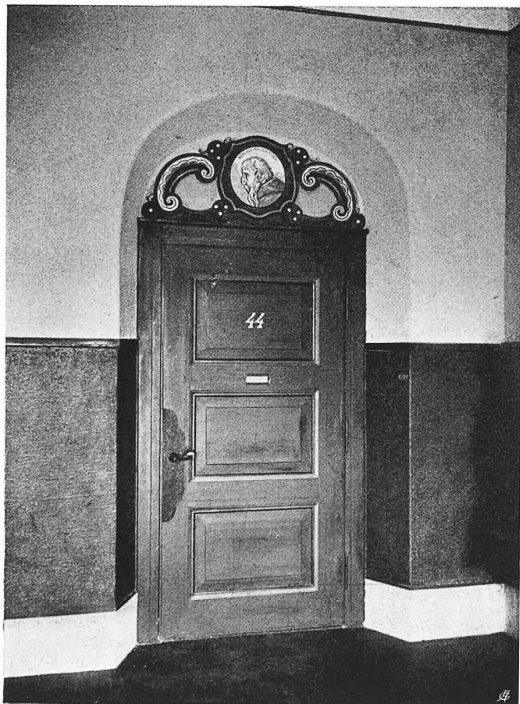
Lehrzimmer im Erdgeschoss, neben dem Haupteingang.
